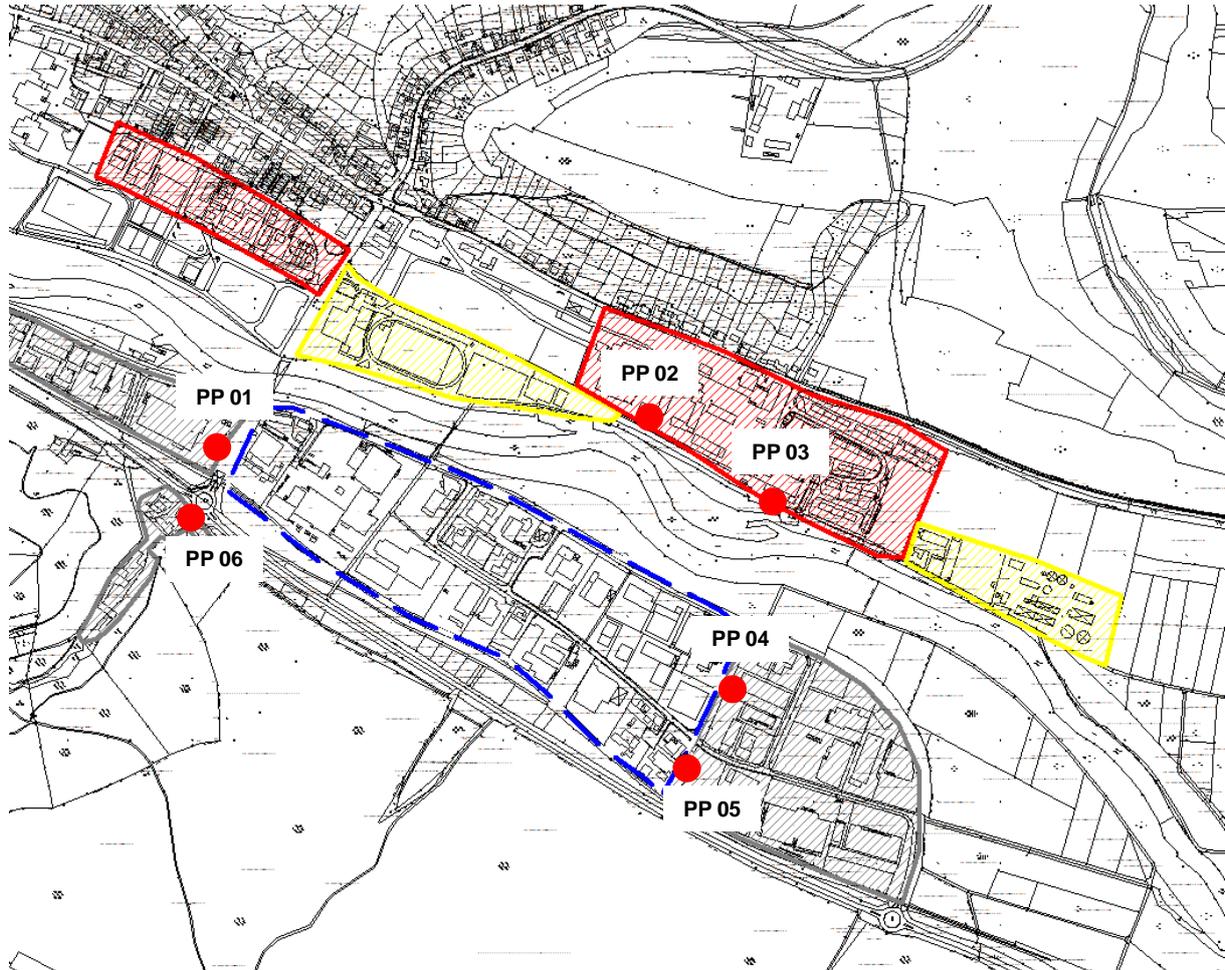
Lageplan mit Prüfpunkten (nicht maßstäblich)
